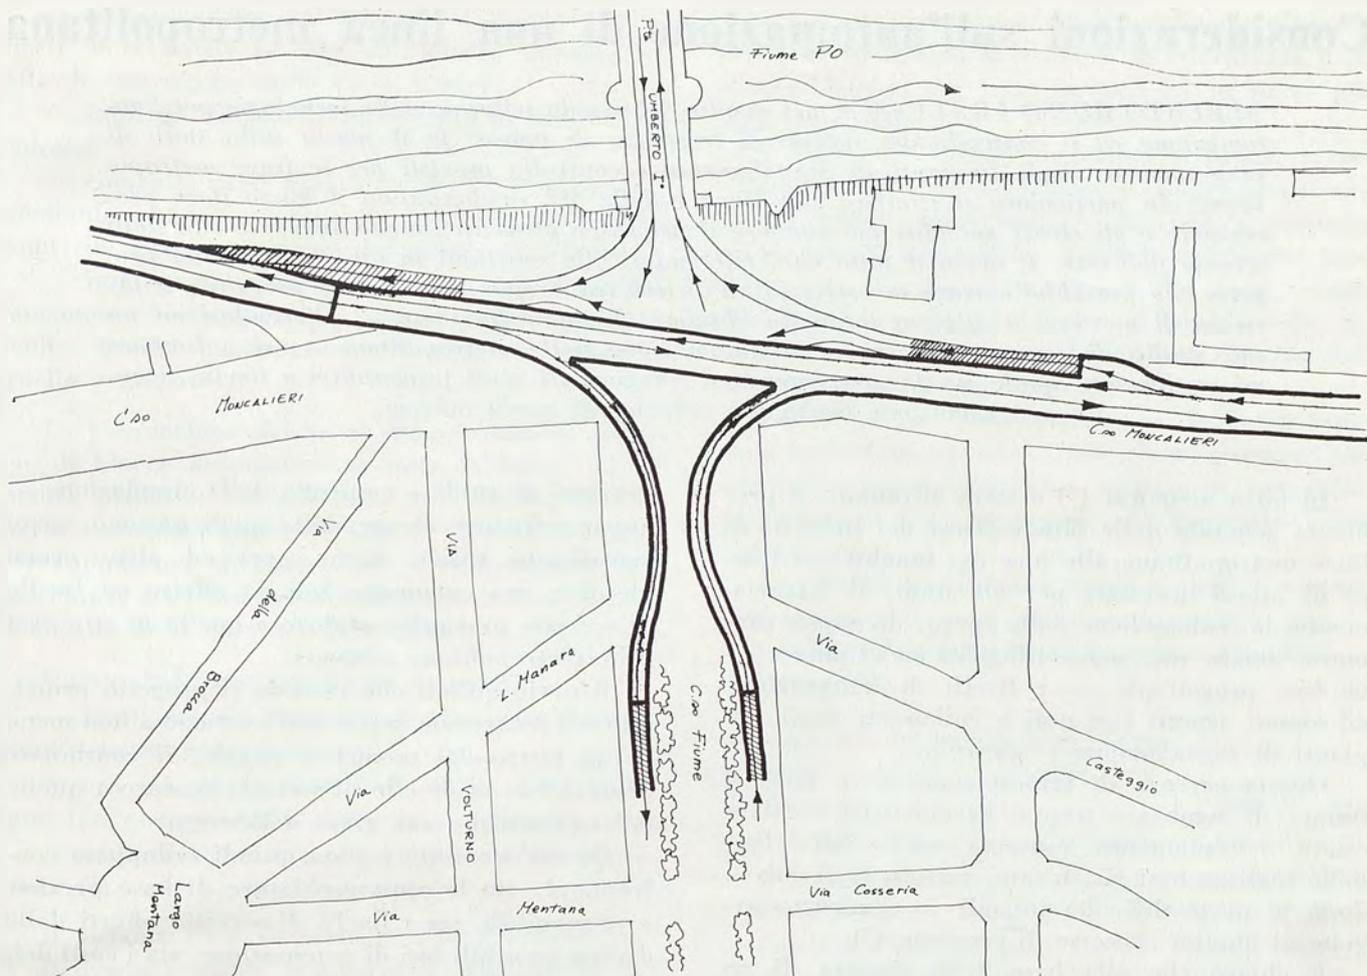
Planimetria dell'interscambio di Corso Fiume.
